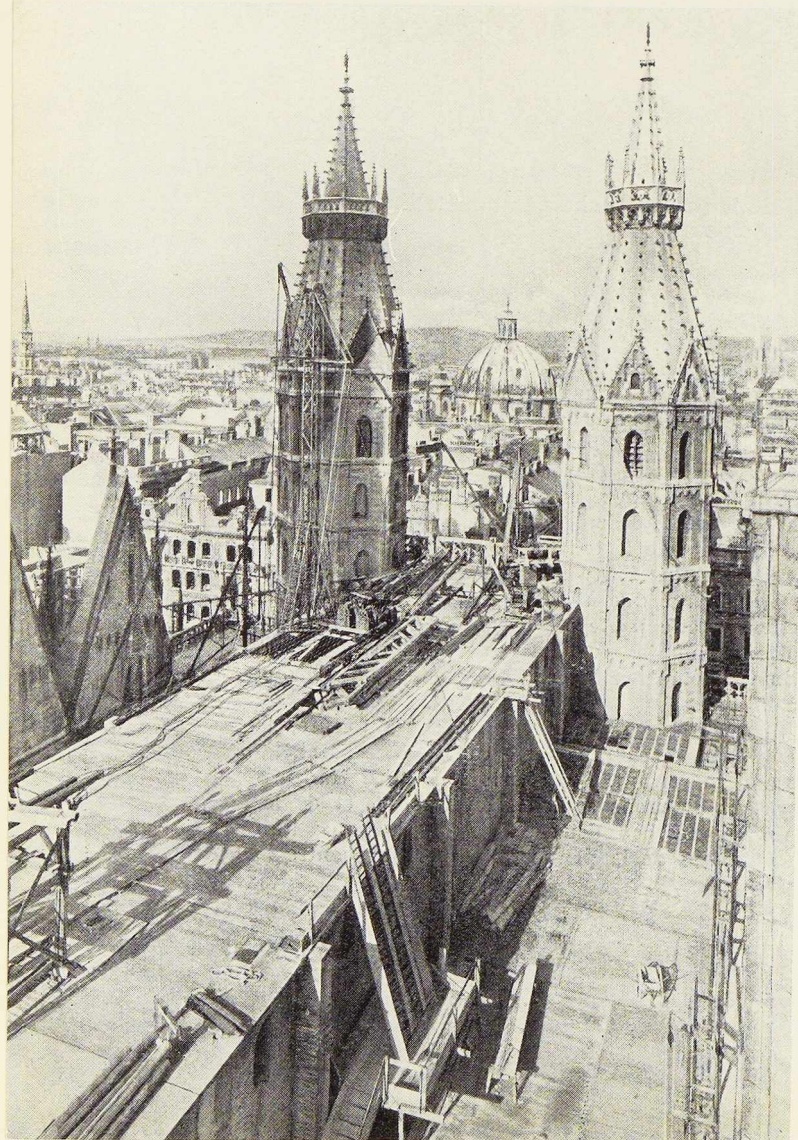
Vue de la toiture après exécution des travaux préliminaires (les dalles en béton armé sont achevées).
